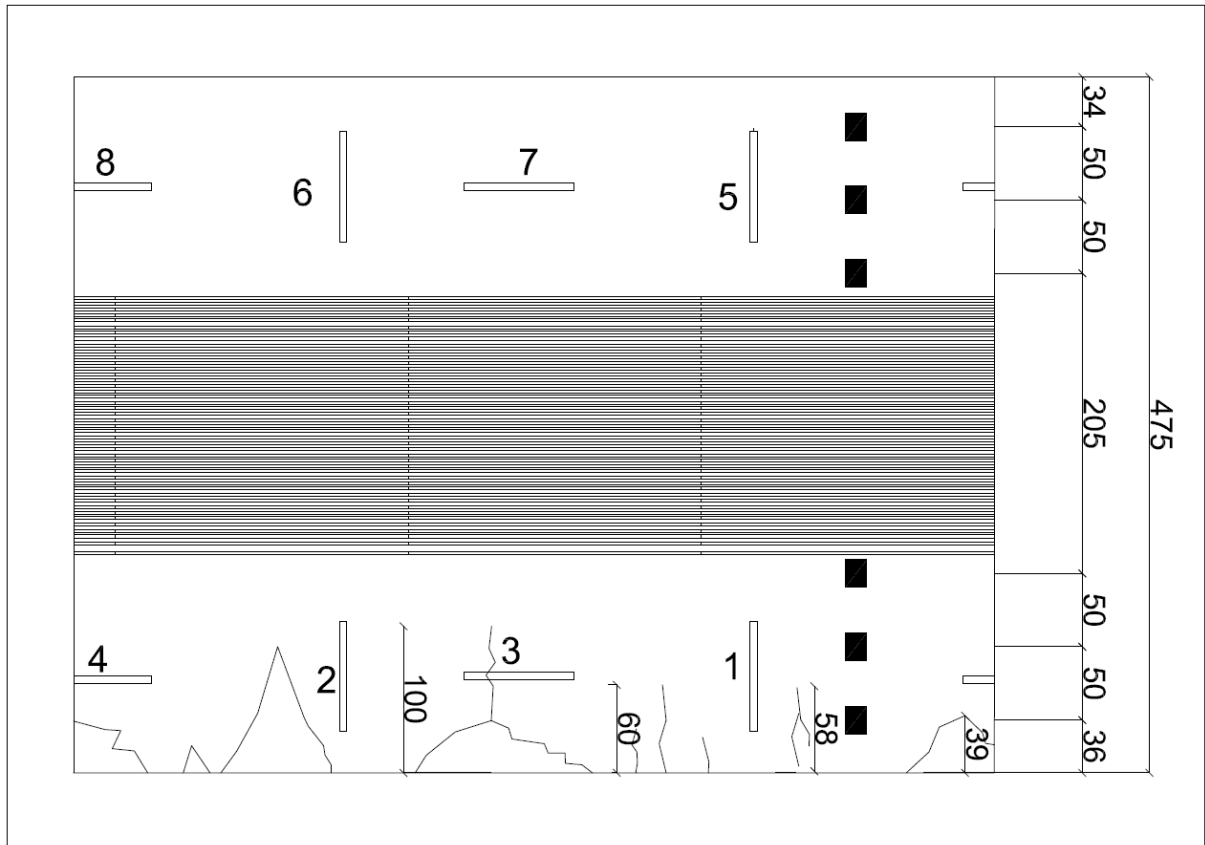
Position des fissures de béton sur la surface extérieure du cylindre R1. Les positions des jauges sont également indiquées.
